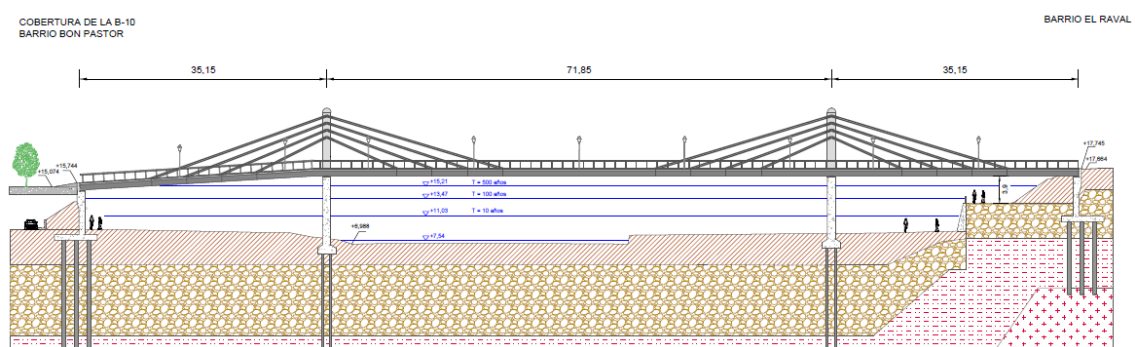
Vista en alzado de la pasarela. Alternativa 3 (Fuente: Elaboración propia).
